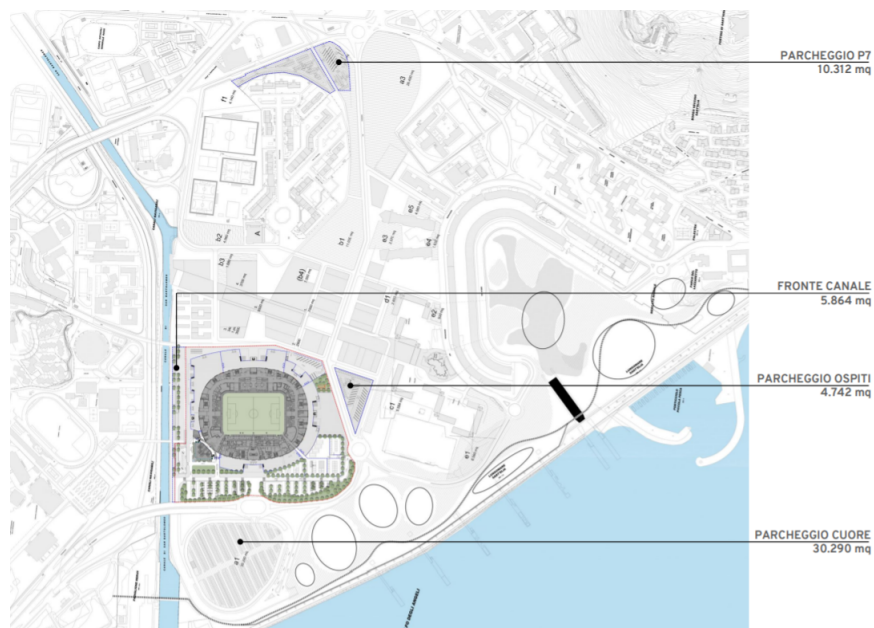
Planimetria di inquadramento con parcheggi pertinentenziali
